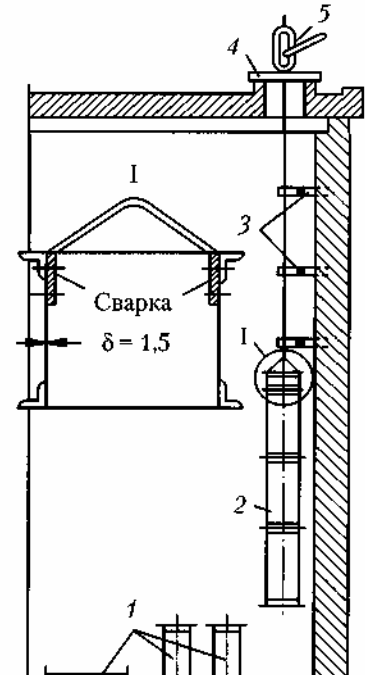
Монтаж вертикальных воздухопроводов методом наращивания снизу: 1 — воздухопроводы; 2 — наращиваемый блок; 3 — кронштейны; 4 — монтажная балка; 5 — лебедка
